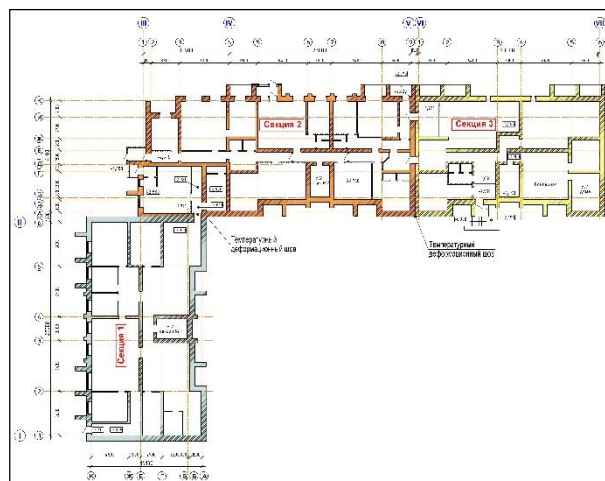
План цокольного этажа жилого дома на улице Ломоносова
